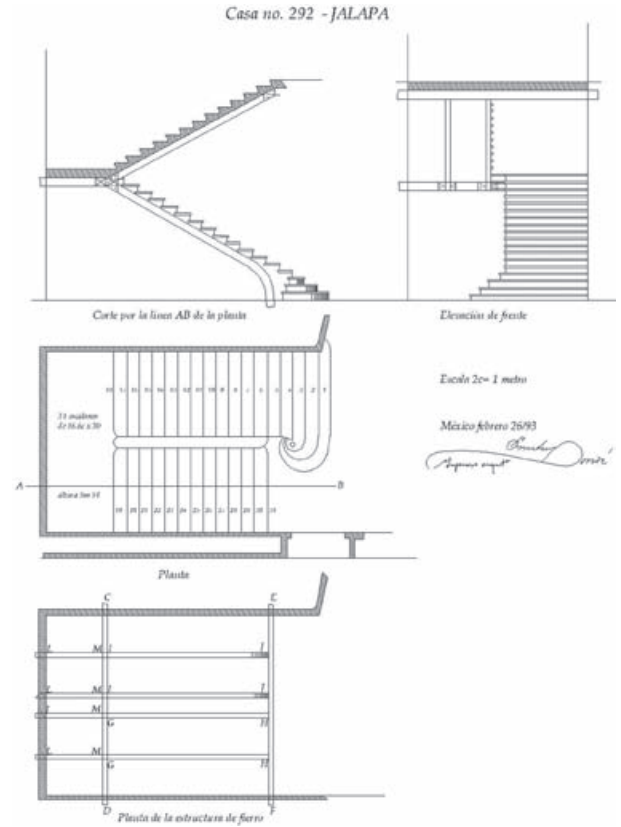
Planta de la estructura de hierro para escalera. Dibujos elaborados por la arquitecta Nancy Aracely Ambrosio Ángeles. Unidad de Informática, CNMHNAH.
